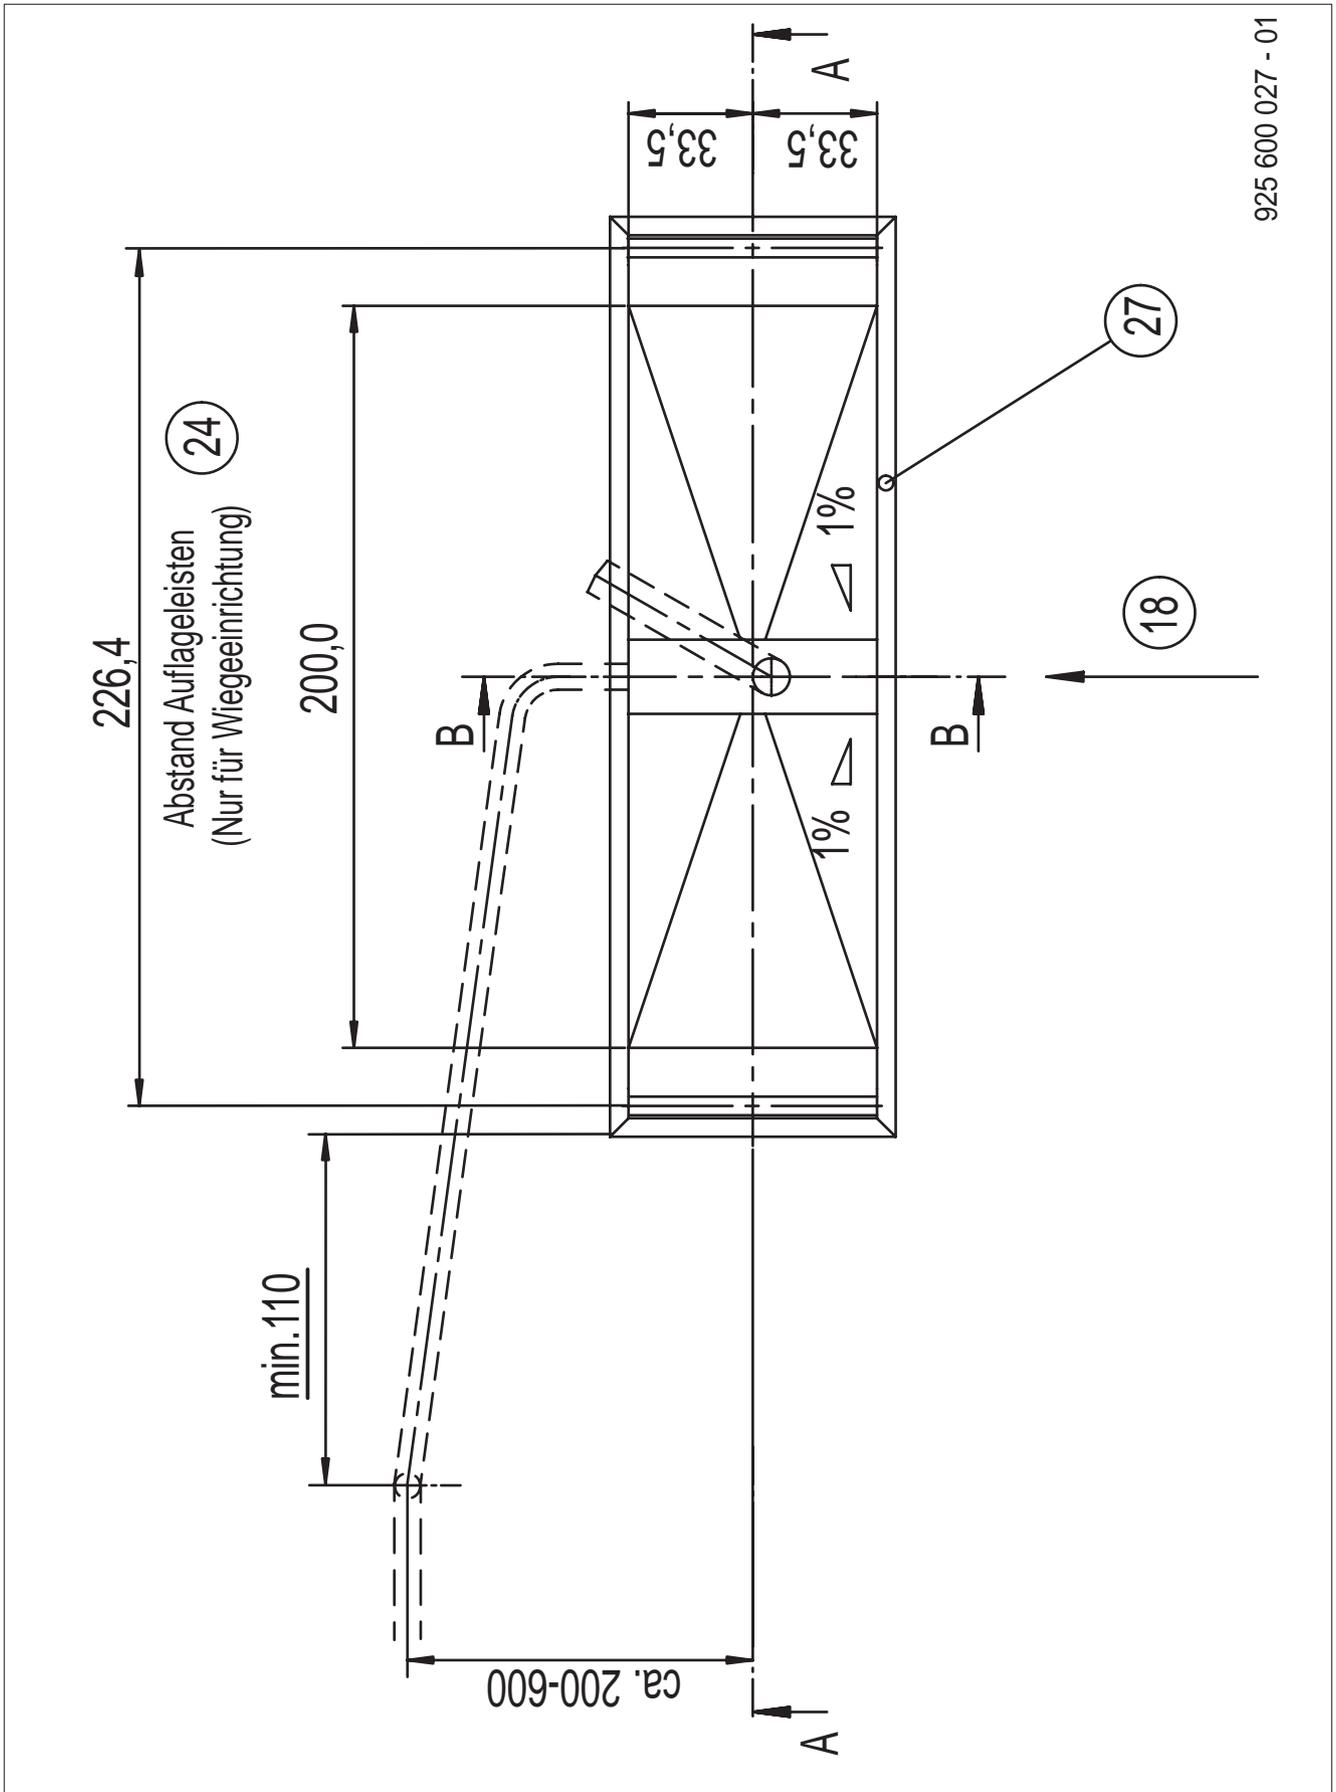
Grubenplan BD 6xx mit Standsäule - Grundriss
